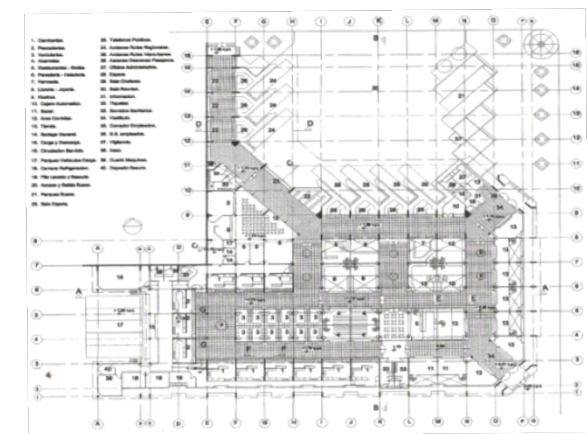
Planta arquitectónica, Mercado Municipal y Terminal de Buses en Atenas, Zeledón, 2000.
